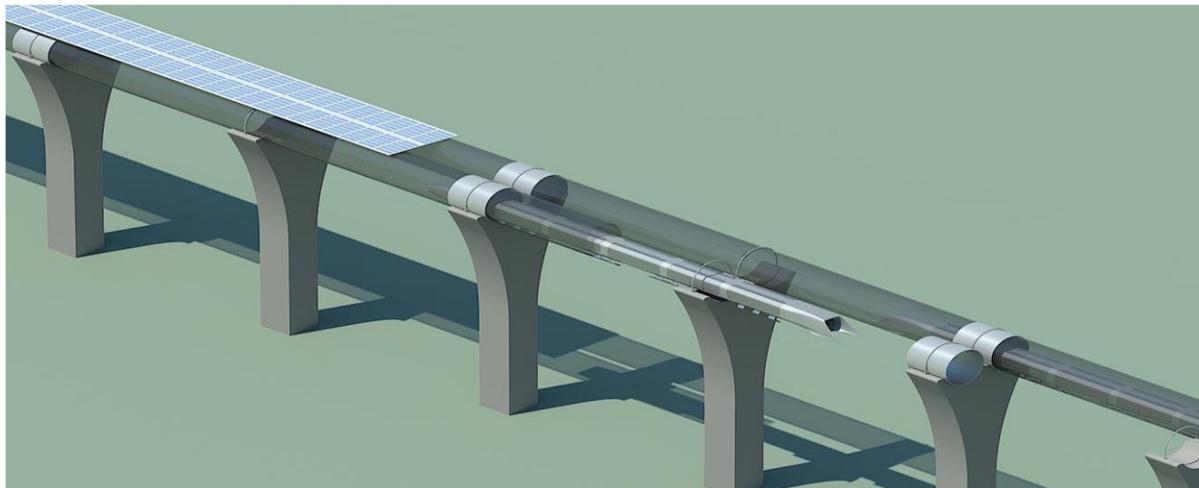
Fonte Hyperloop Virgin, disposizione Piloni infrastruttura Hyperloop
